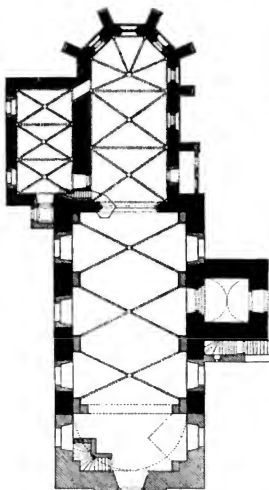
Řečic-Kardaš. Grundriss der Kirche.
